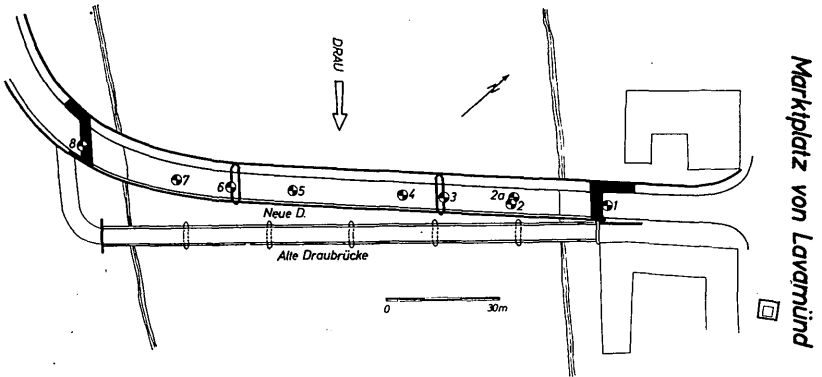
Lageplan der Lavamünder Draubridgen (Bohrpunkte 1—8)
